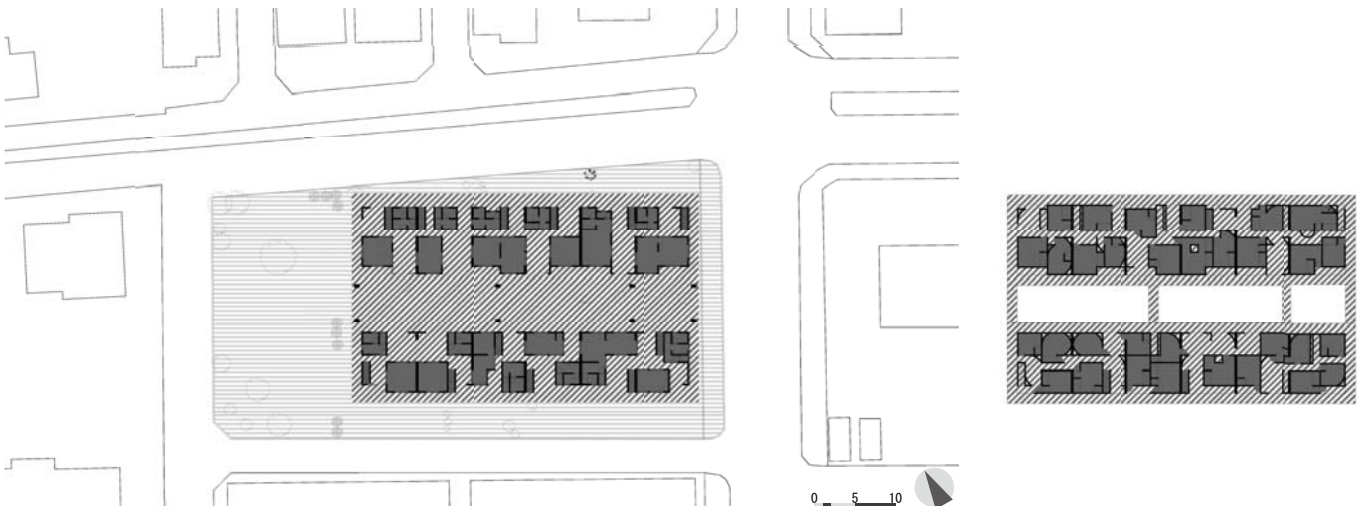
改修1階平面図(左)・改修2階平面図(右)(色分け：図2参照)
